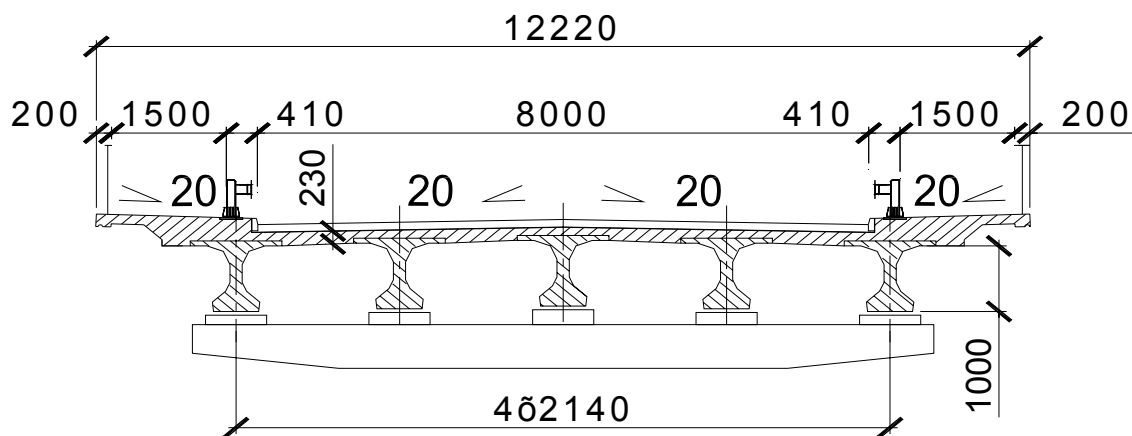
Поперечний переріз шляхопроводу на км 261+441
